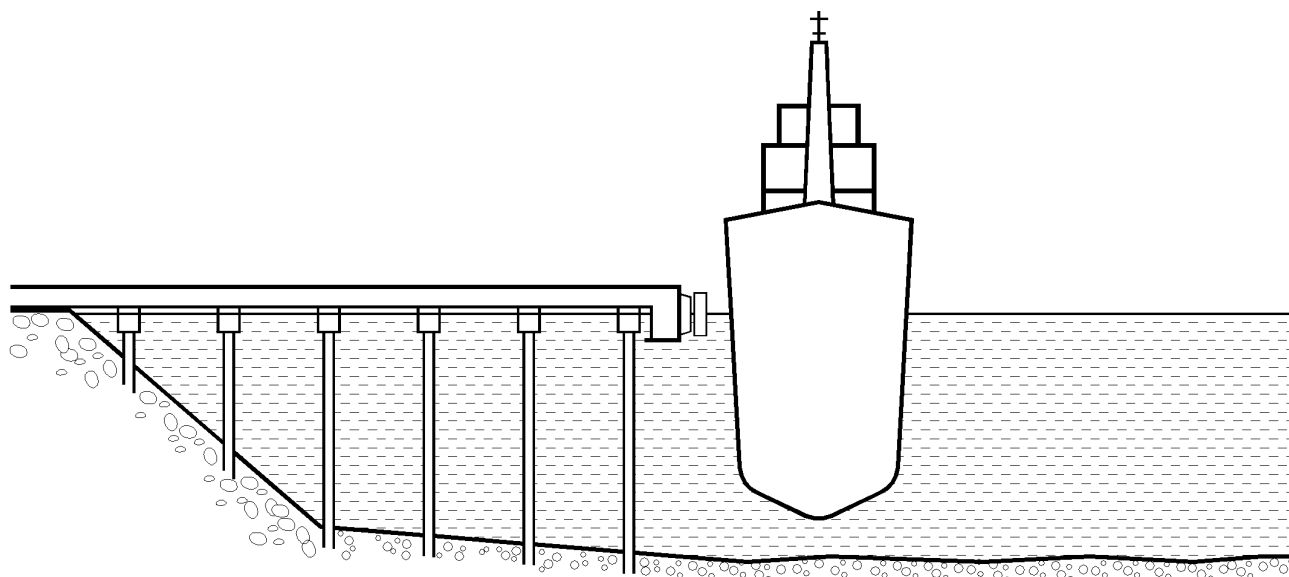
Muelle con Pilotes o Pilas descubiertos
